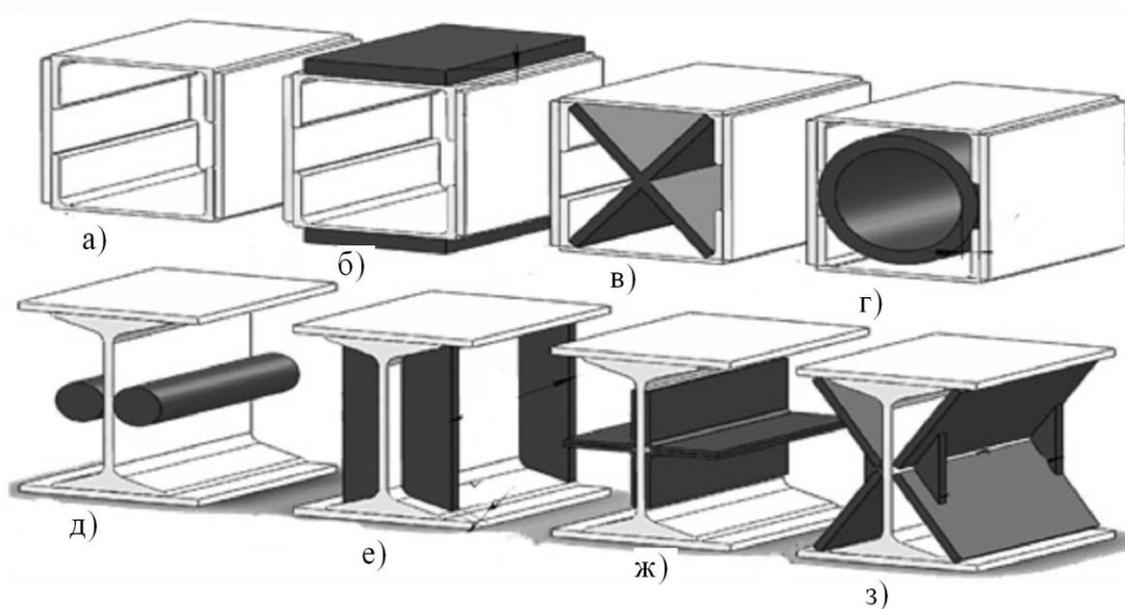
Способы увеличения прочности балок коробчатого сечения и двутавров: а - балка без усиления; б - балка с усиливающими пластинами; в - балка с усиливающими ребрами; г-балка с усиливающей трубой; д – двутавр с усиливающими арматурными стержнями; е - двутавр с усиливающими ребрами; ж - двутавр с усиливающими уголками; з - двутавр с X-образными усиливающими элементами.
